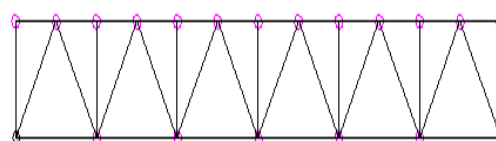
варианты решеток ферм: а – без промежуточных стоек;
